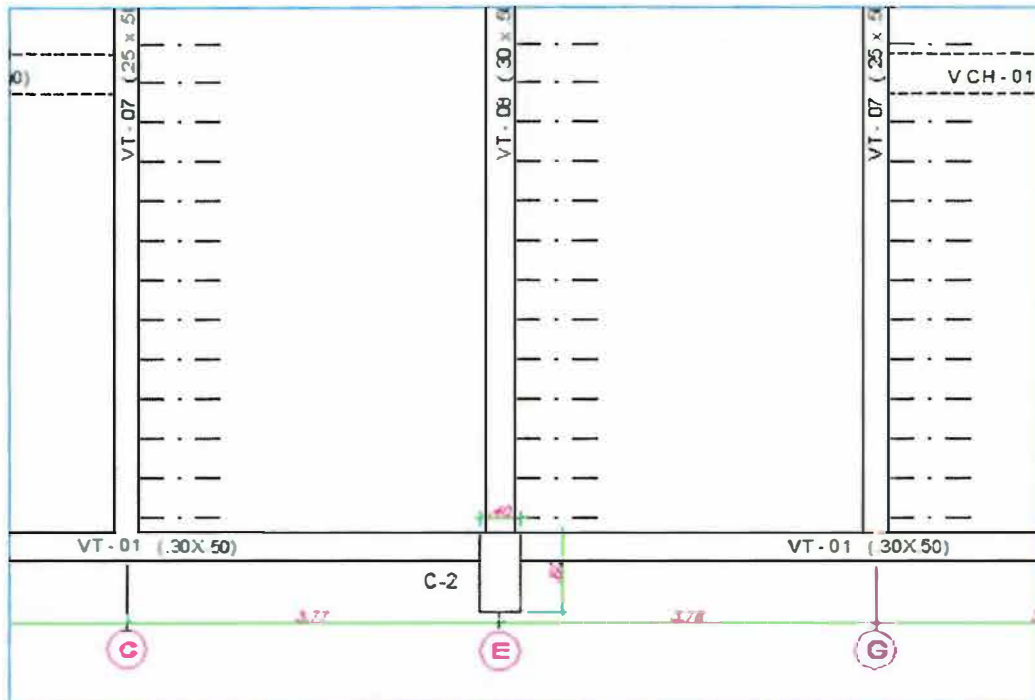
Columna central C-2 pertenece a pórtico de fachada
